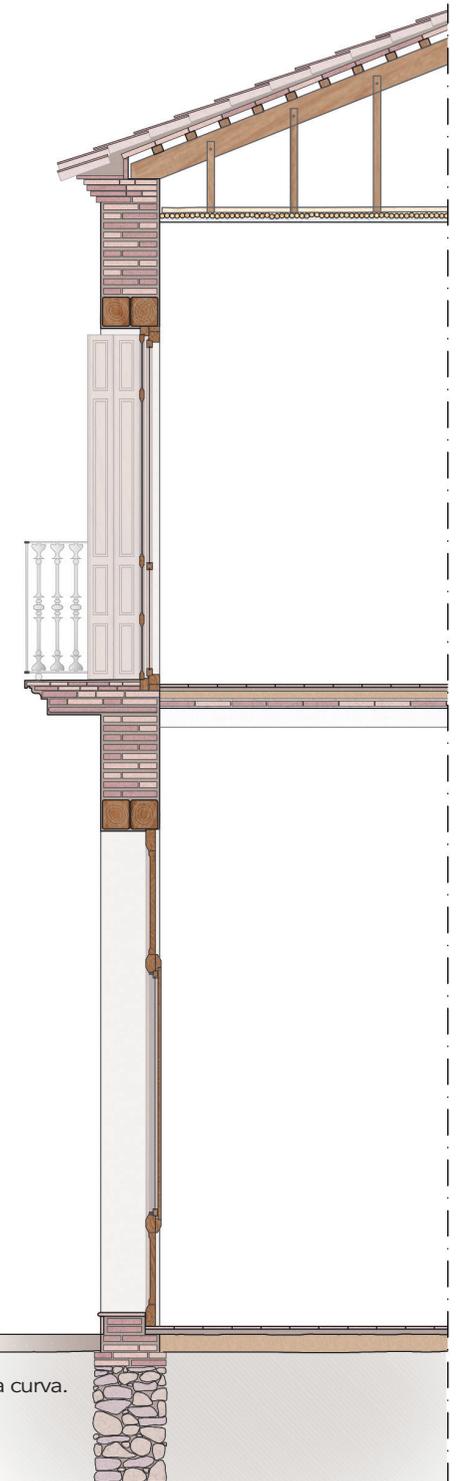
Sección constructiva parcial de un ejemplo tipo B realizado con muros de ladrillo y cubierta inclinada de viguetas con entabecado de rasilla y teja curva.
